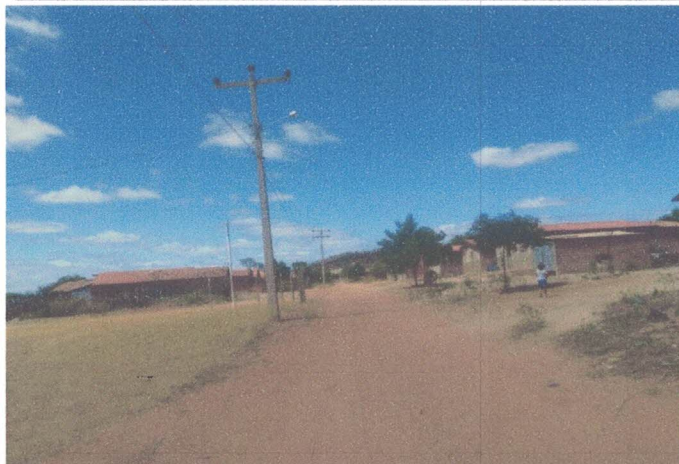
RUA PROJETADA - TRECHO 3
